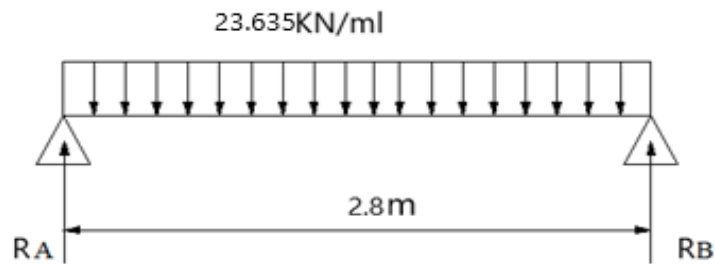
Schéma statique de la poutre palière a l'ELS.
